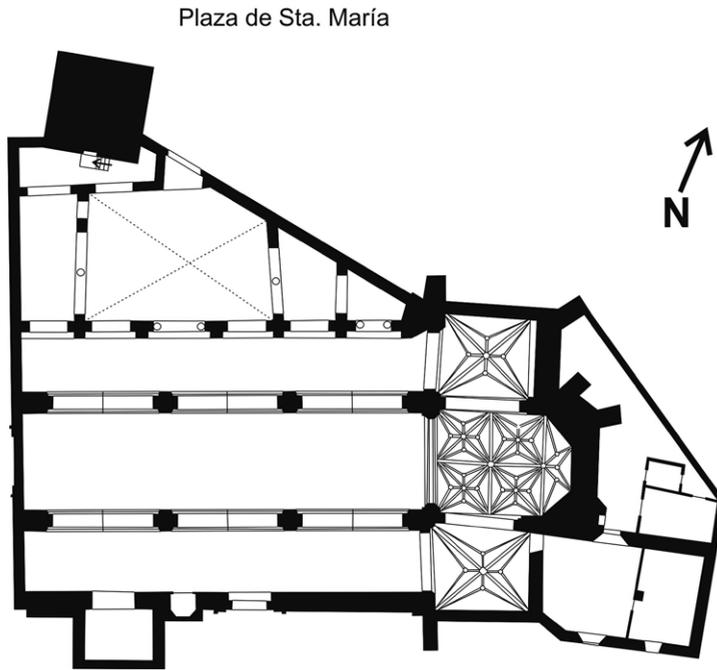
Planta actual de la parroquia de Santa María de la Granada. Autor: elaboración de Enrique Infante Limón a partir de planimetría de Manuel López Vicente.
